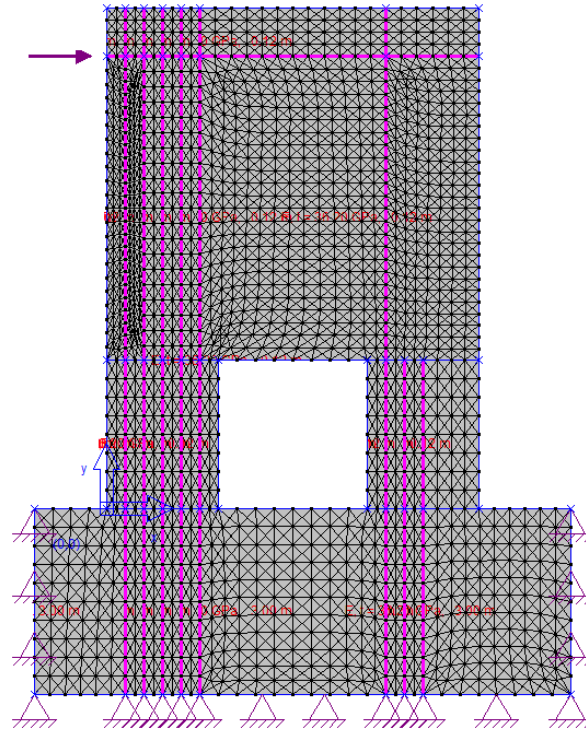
Modelo parede MB 1ee com armadura 1.
